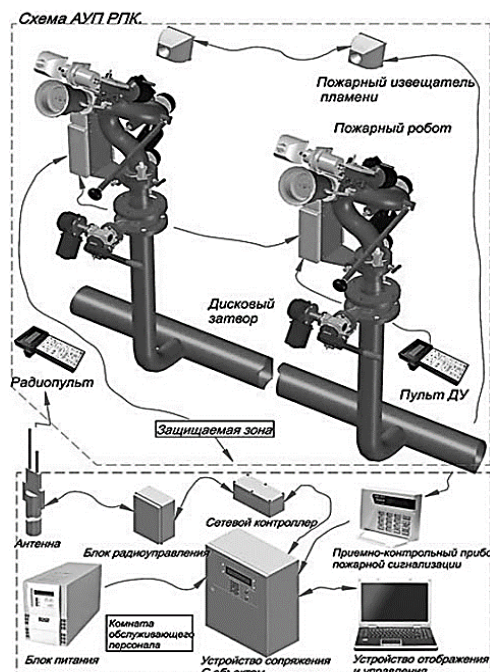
Схема автоматической установки пожаротушения – роботизированный пожарный комплекс
